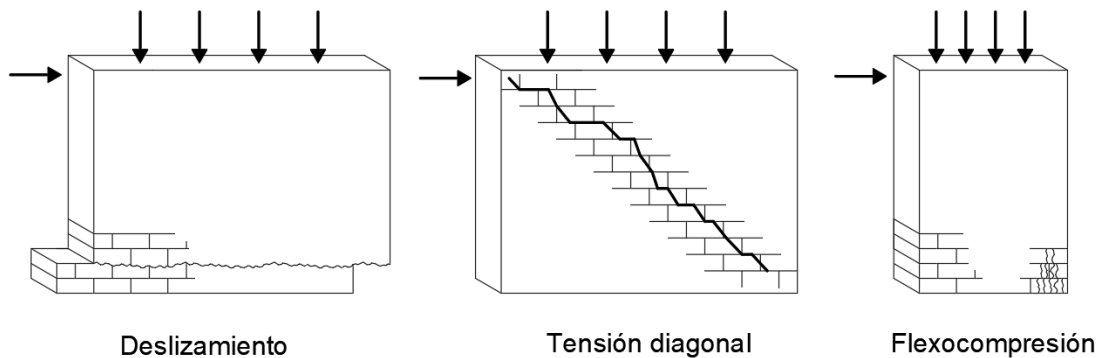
Fallas en muros de mampostería confinados (adaptada de [1]).
